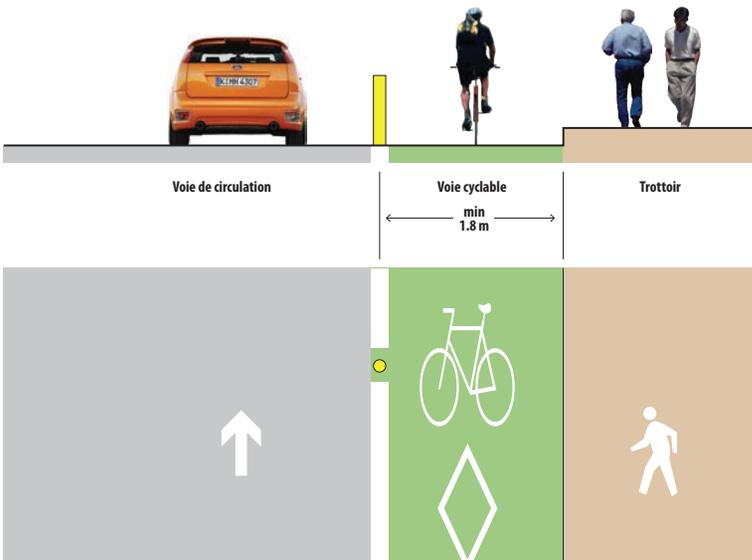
Installation unidirectionnelle séparée latéralement sans stationnement
